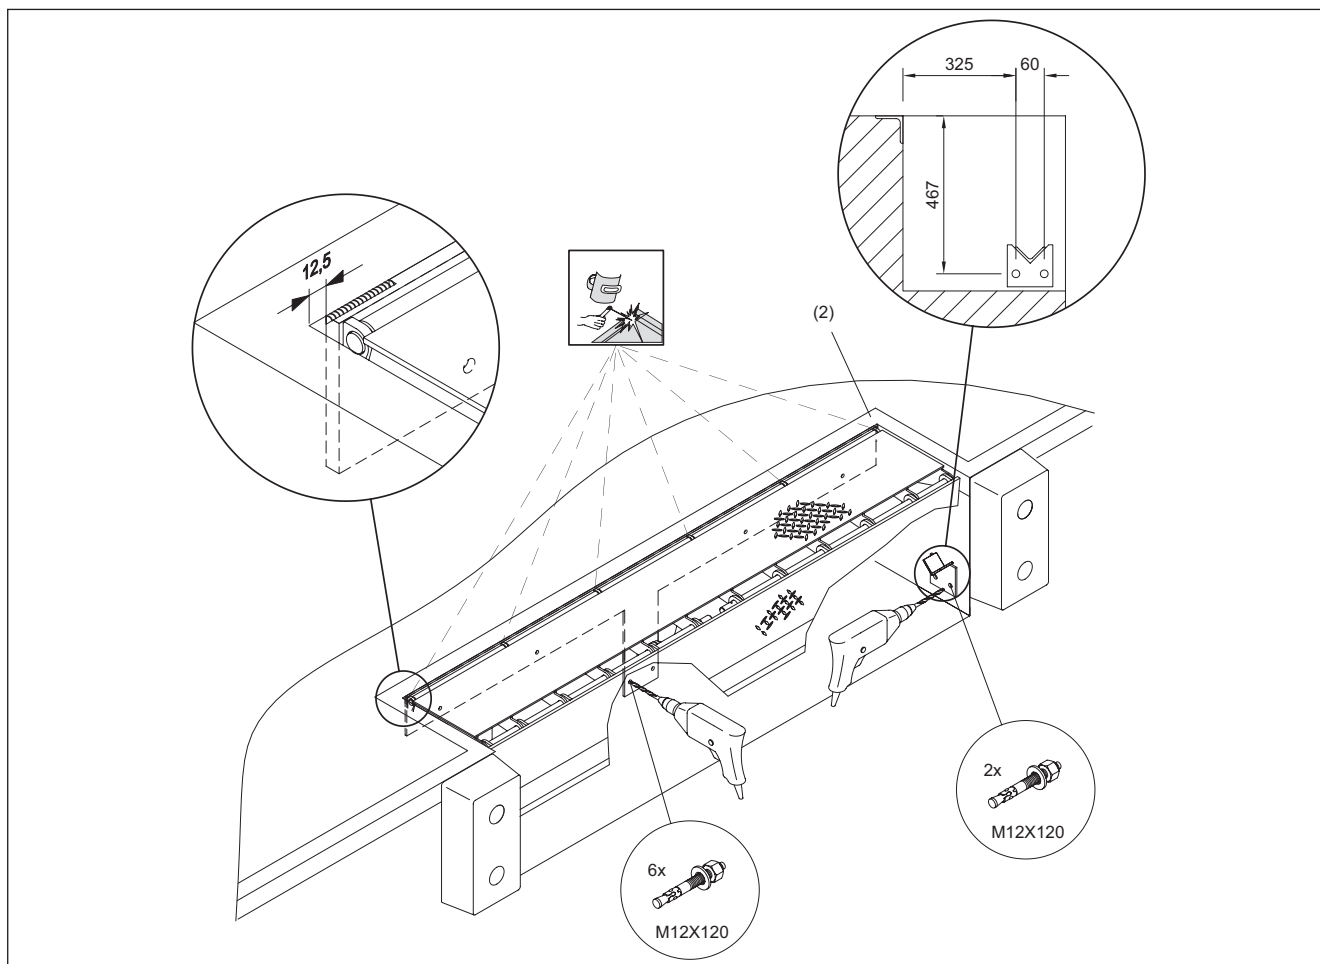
Конструкция MLS для монтажа сваркой в подготовленный приямок
